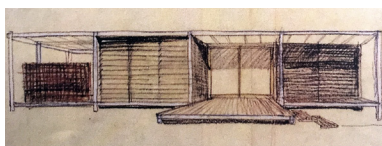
Croqui de estudo de Bratke para o pavilhão.
